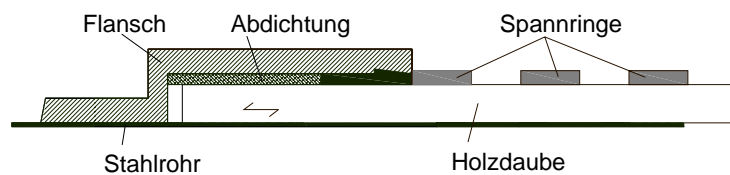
Anschluss an Stahlarmaturen bzw. -rohre
